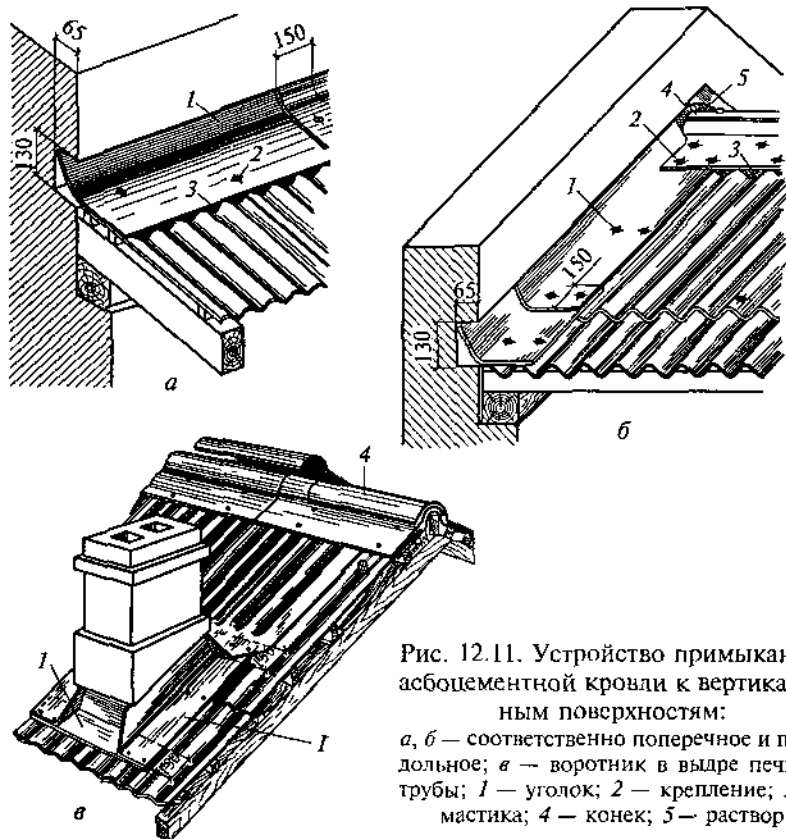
Устройство примыканий асбоцементной кровли к вертикальным поверхностям:
